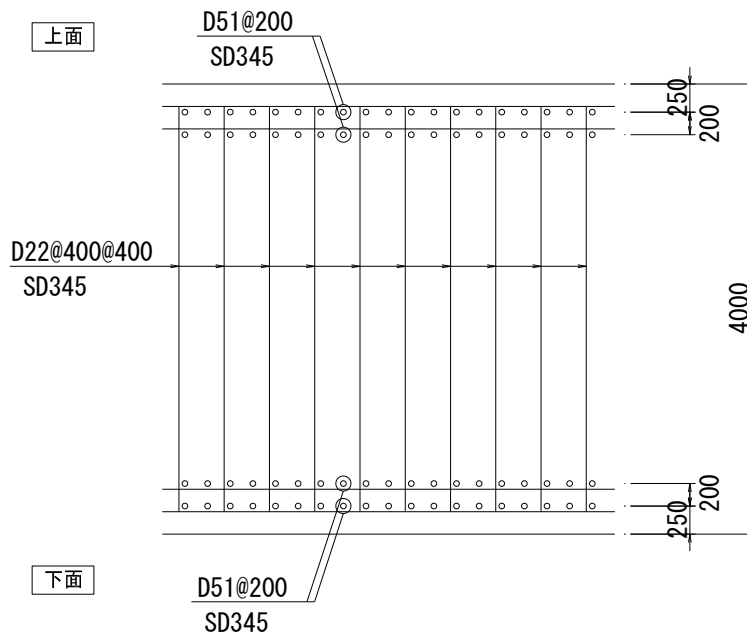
(2) 漂流物対策工基礎スラブの概略配筋図
